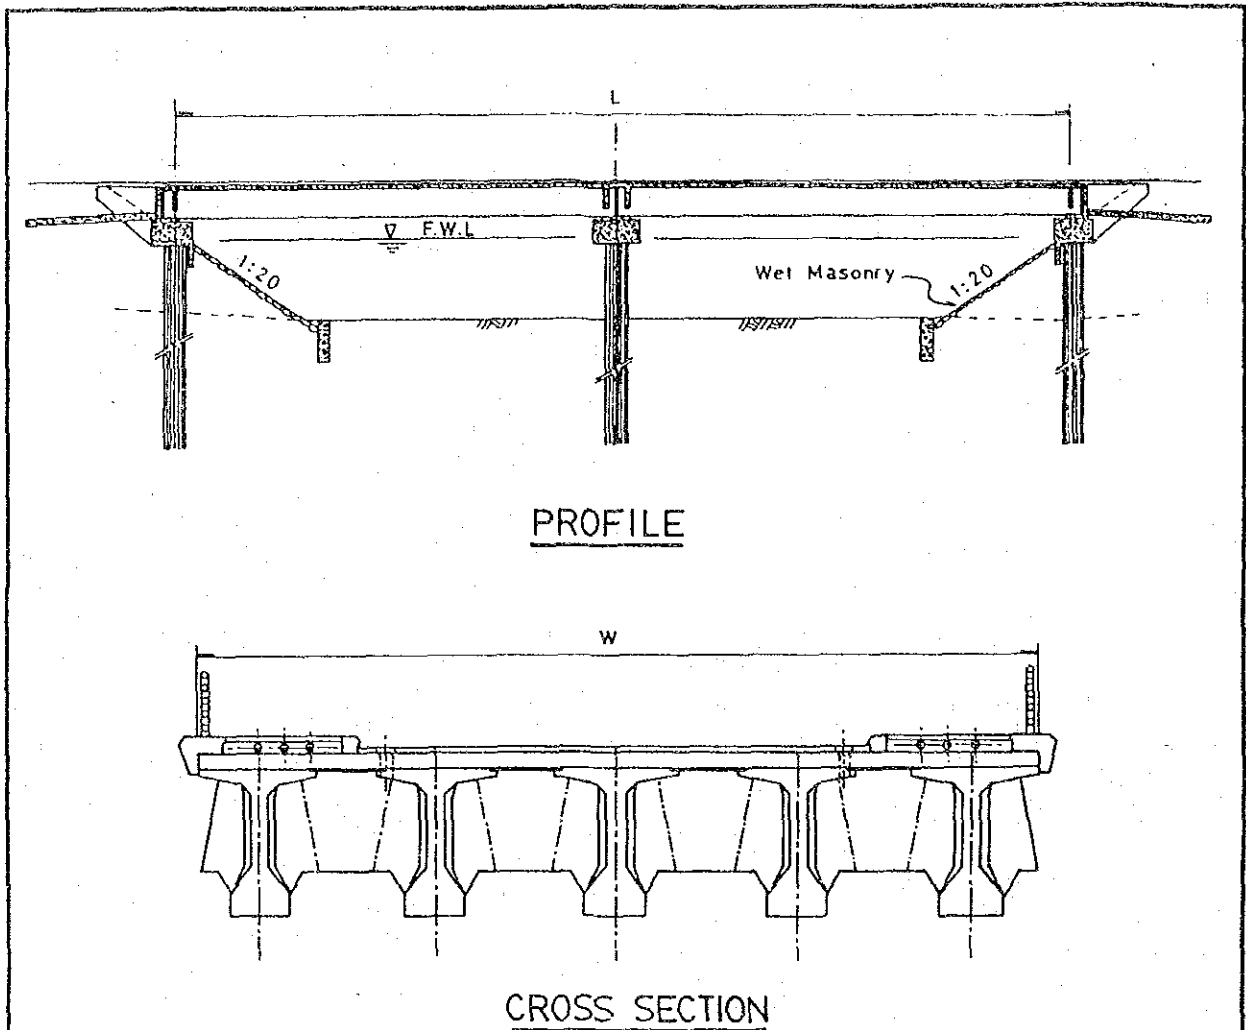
Plan et profils en travers types du pont sur la route touristique
